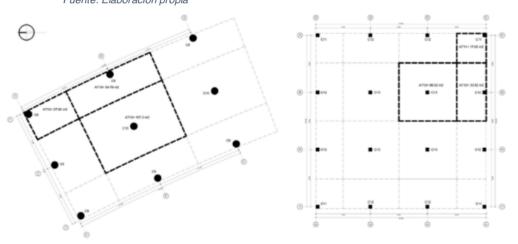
Zona 2 de Sección A Fuente: Elaboración propia
